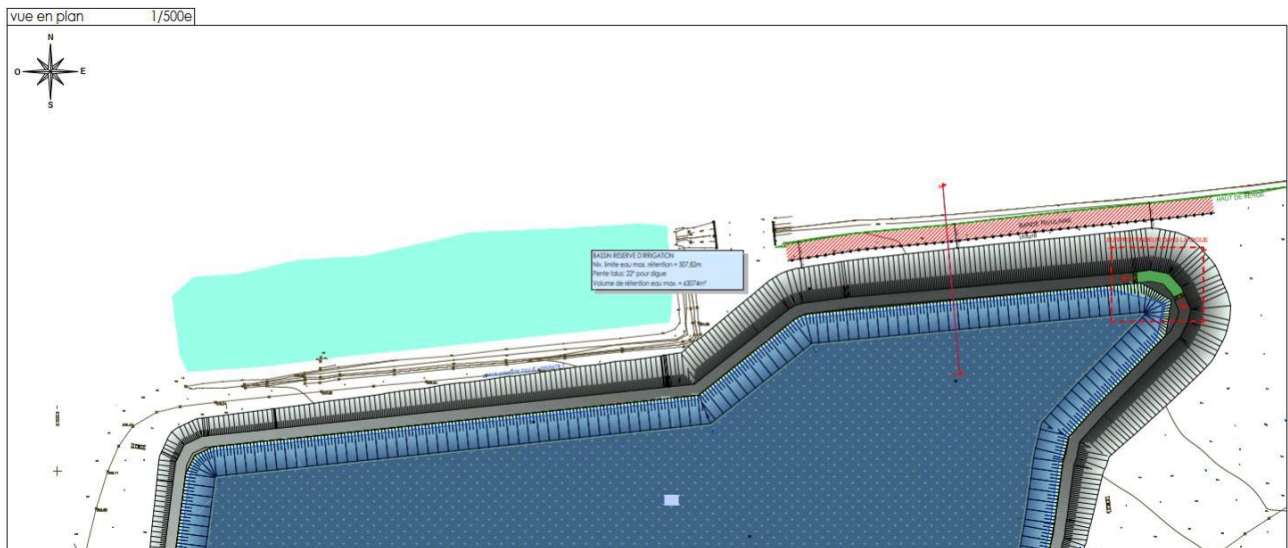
Auszug aus dem Plan „Déplacement du Ruisseau – Coupe dans Talus“: Die abgesenkte Dammkrone ist grün dargestellt (Luxplan S.A. 02/2024).
